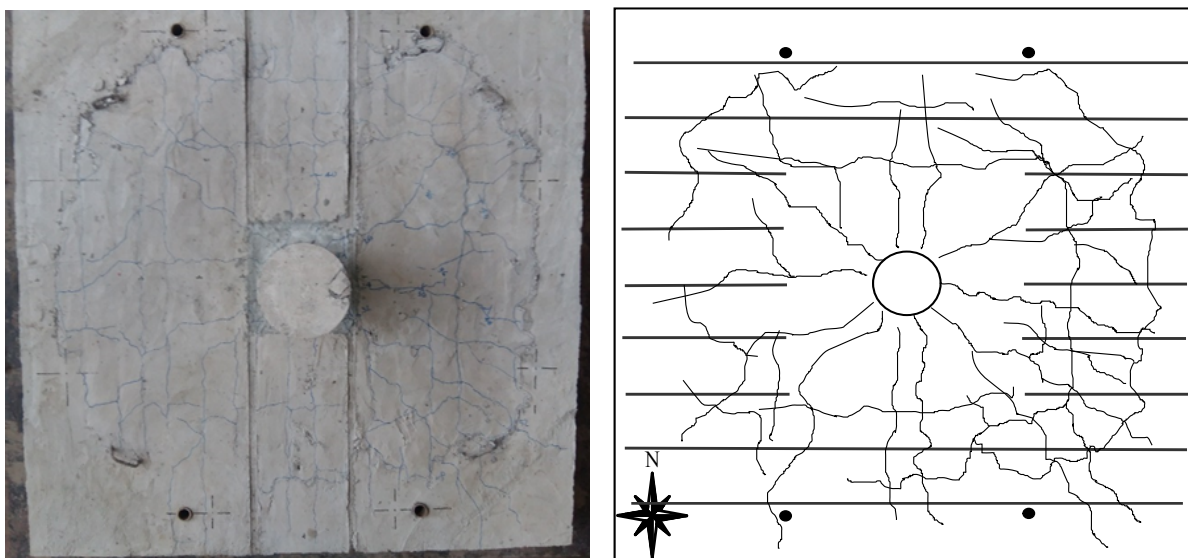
Mapa de fissuração - Laje BD-A05
